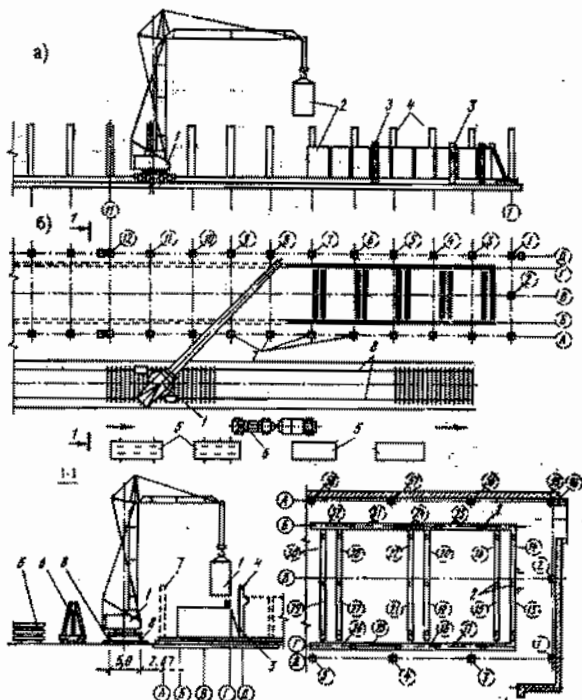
Схема монтажа блока фильтров и отстойников башенным краном (объектный поток 1): 1 - монтажный кран; 2 - стеновые панели; 3 - лестница; 4 - колонны; 5 - сборные элементы, подготовленные для монтажа; 6 - панелевоз; 7 - места установки колонн по оси А; 8 - подкрановый путь; (1 ... 13) - колонны ряда по оси Д; (13 ... 32) - панели ячеек фильтров; (46 ... 53) - колонны по оси А
